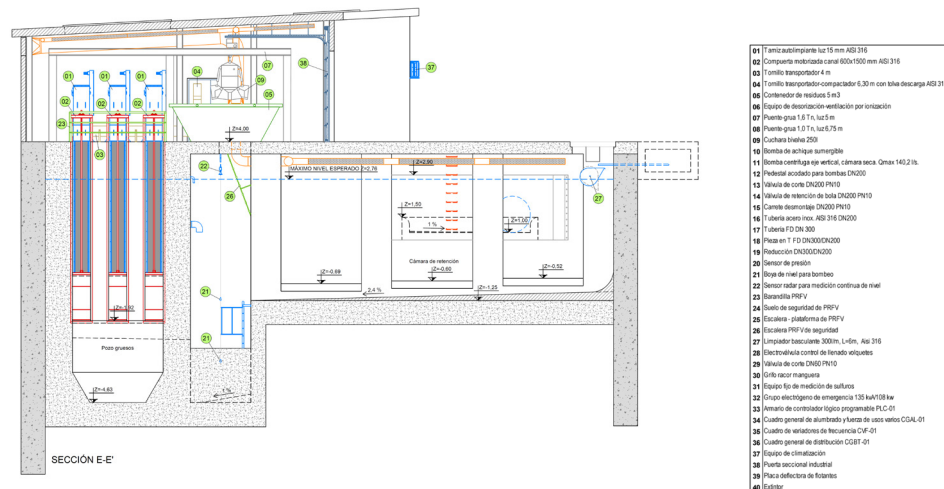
| Sección en alzado del proyecto constructivo del nuevo tanque de tormentas de Rianxo.
